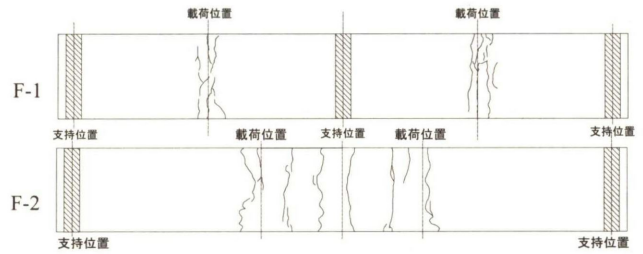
F-1とF-2の最終ひび割れ状況
